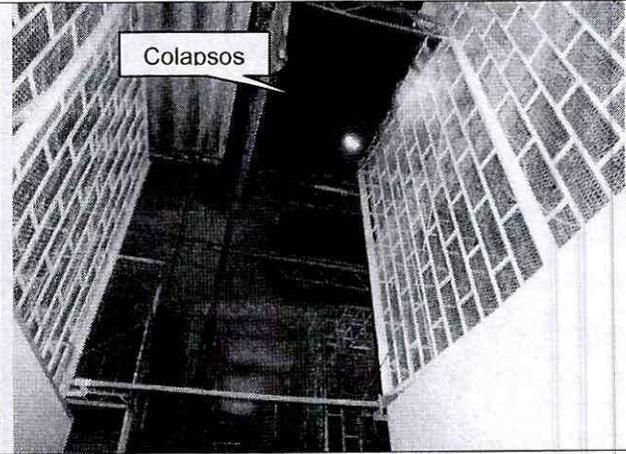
Vista de una fracción de la cubierta en placas de concreto de la zona donde se presentó la conflagración; se observa desprendimientos del concreto de placas, vigas y columnas que exponen el acero de refuerzo.
